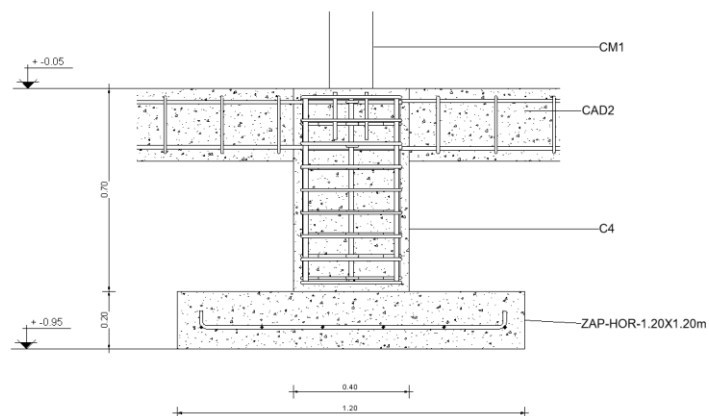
Ficha técnica de modelado de zapata de hormigón.
